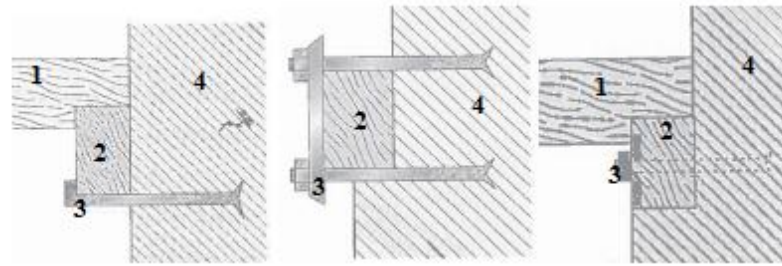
Tipos de ligações parede-piso: 1-Viga de madeira; 2-Frechal; 3-Conetor metálico; 4-Parede de alvenaria. (Appleton, 2005)
